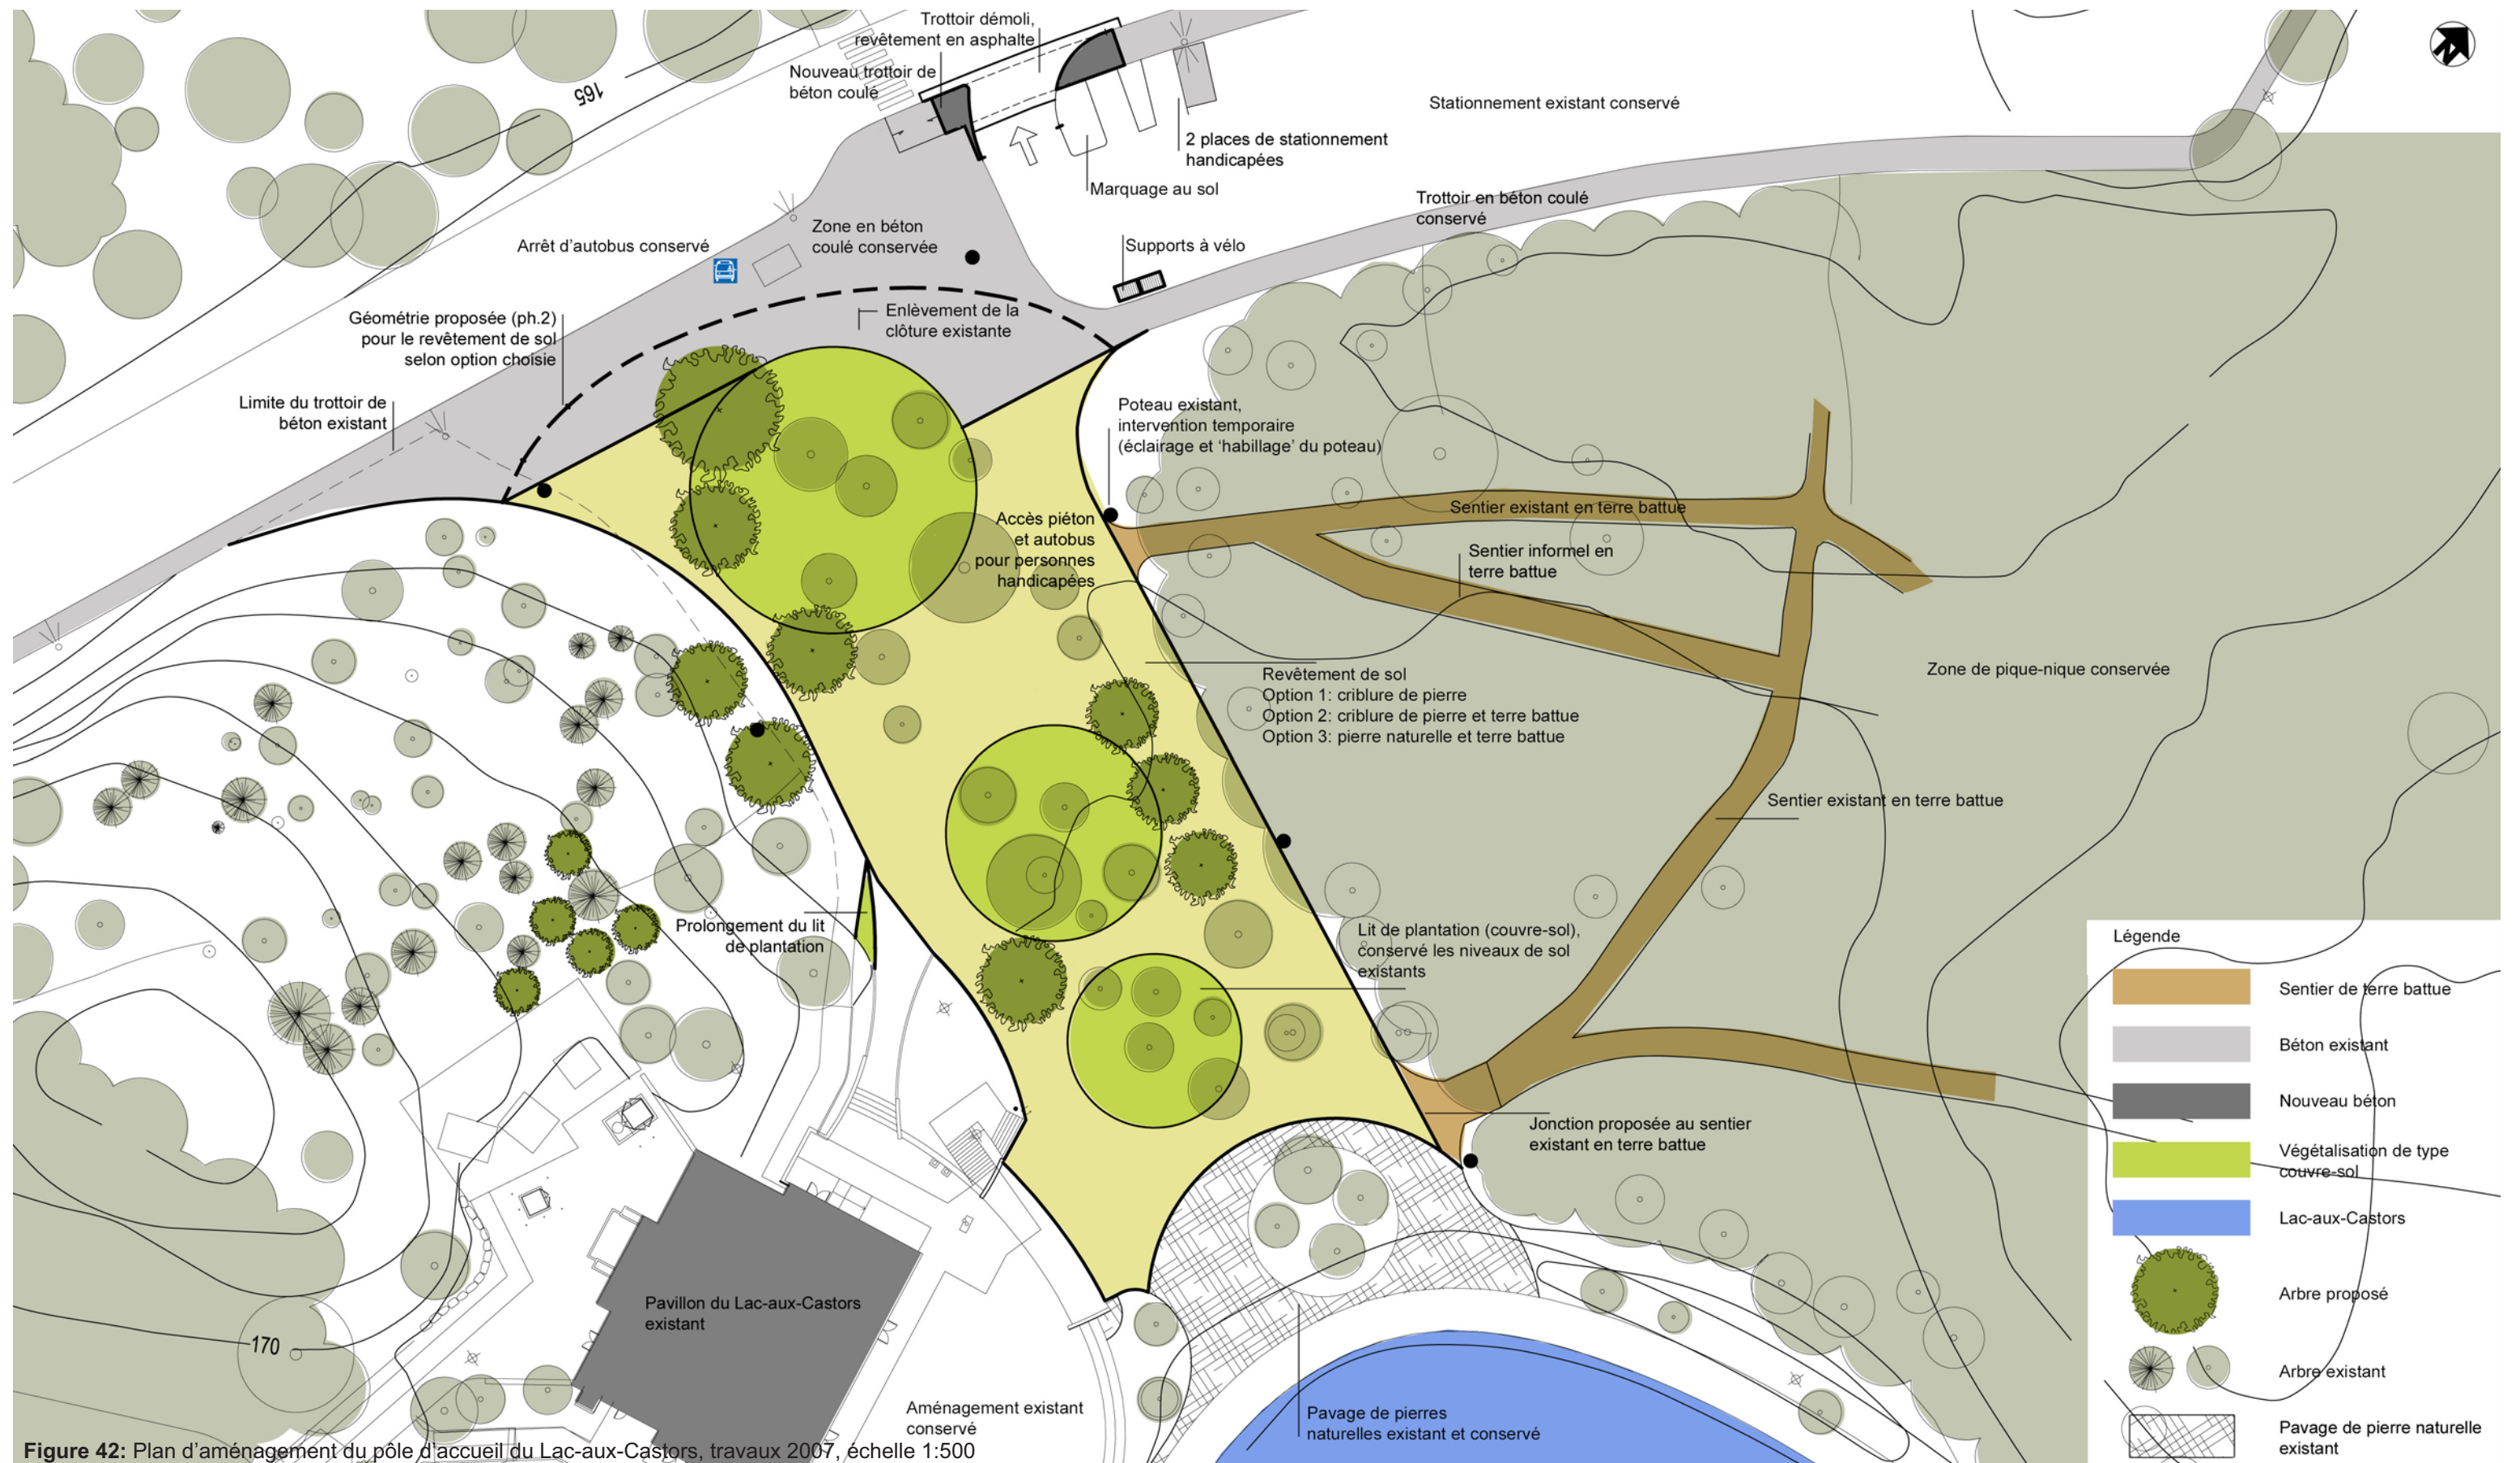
Plan d'aménagement du pôle d'accueil du Lac-aux-Castors, travaux 2007, échelle 1:500
